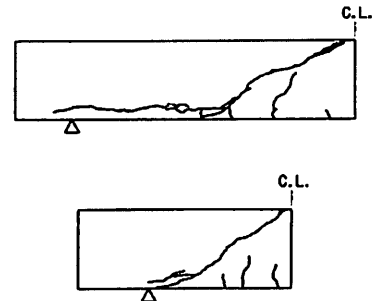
実験終了時のひび割れ状況<sup>9)</sup>
